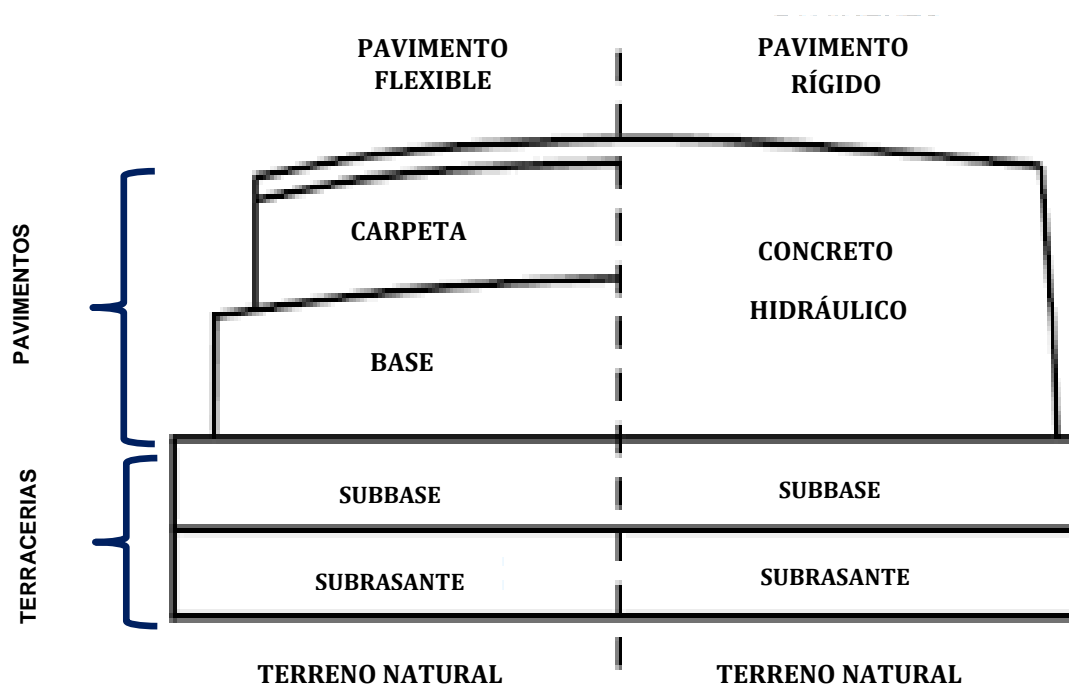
Estructura de Pavimento Flexible y Rígida. ^[27]
